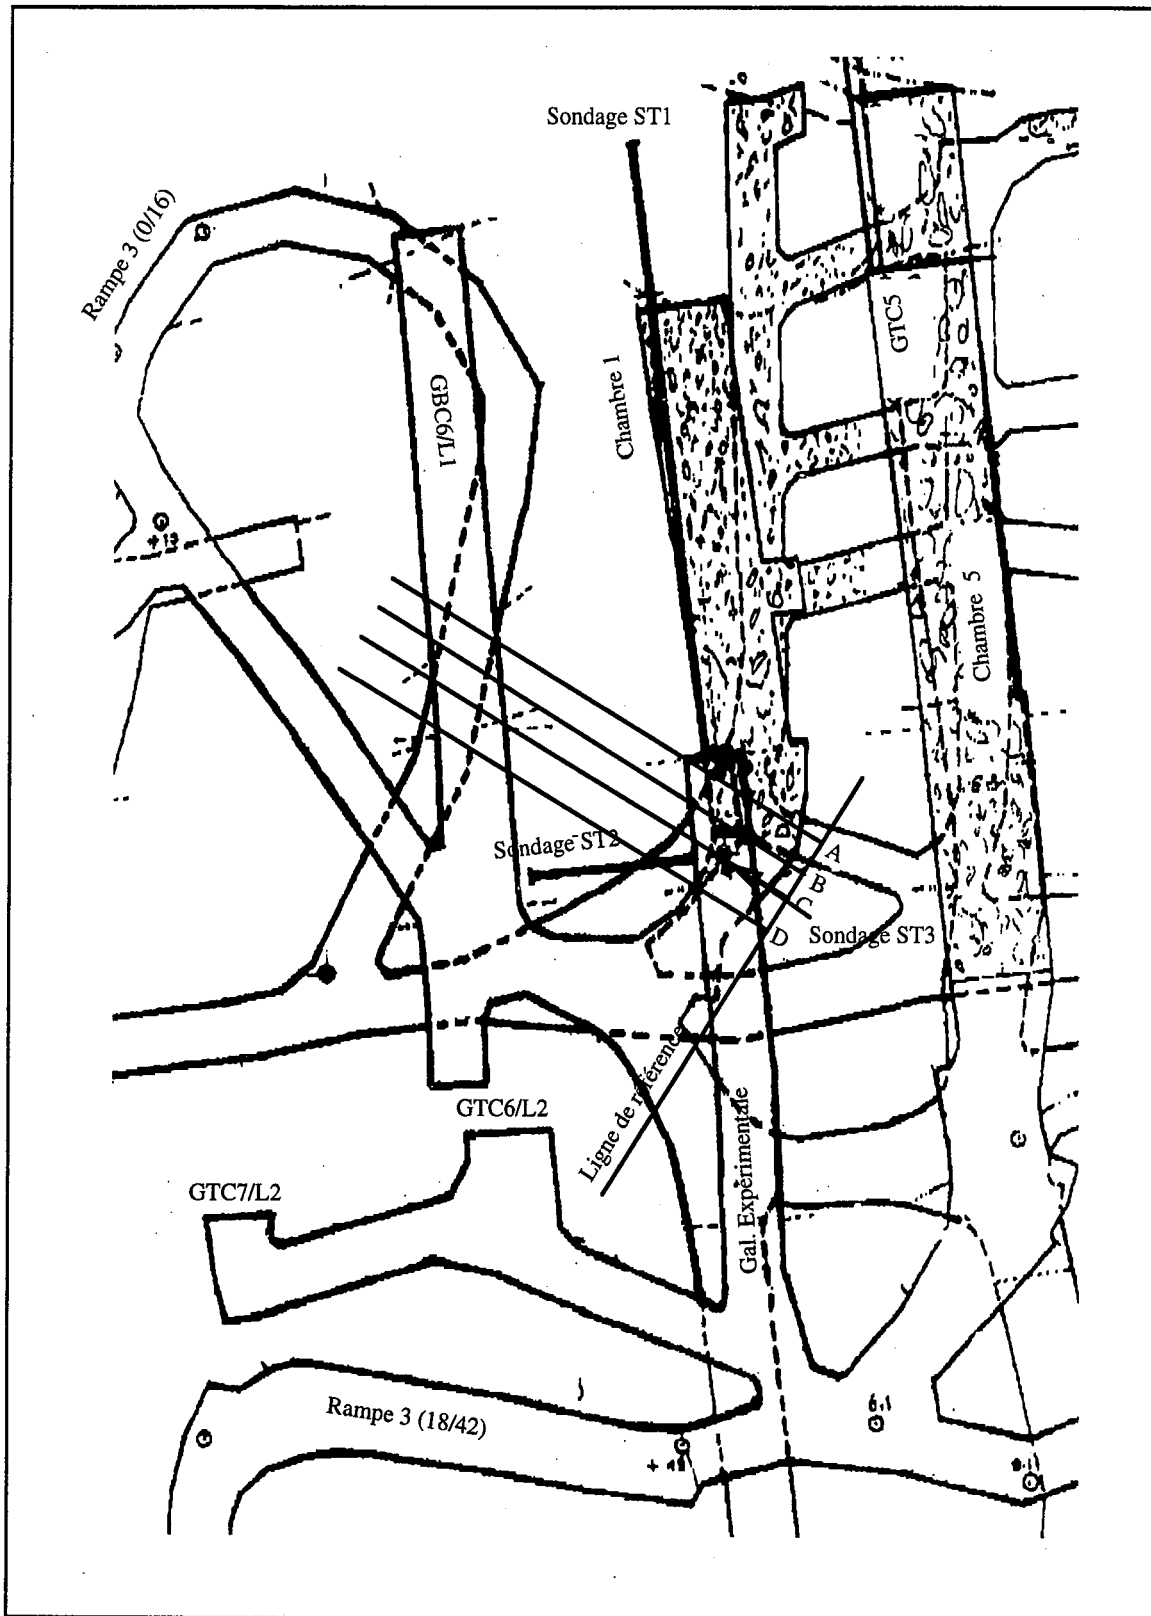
Plan montrant la position des sections de câbles d'ancrage dans la galerie expérimentale
